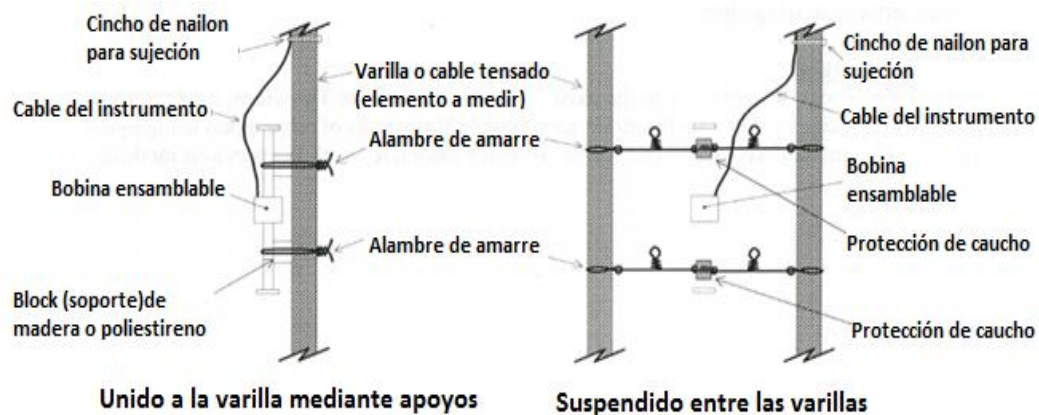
Sujeción de deformímetro a las barras de refuerzo.
